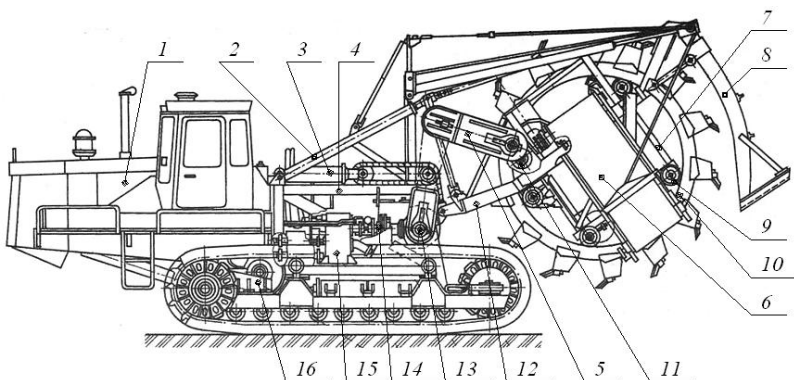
Многоковшовый роторный экскаватор-траншекопатель ЭТР-204А: 1 – тягач; 2, 3 – механизмы подъема рабочего оборудования; 4 – рама тягача; 5 – шарнирная цепная передача; 6 – конвейер; 7 – рама ротора; 8 – устройство зачистное; 9 – ролики; 10 – ротор; 11 – вал привода; 12 – рабочее оборудование; 14 – муфта предельного момента; 13, 15, 16 – редукторы
